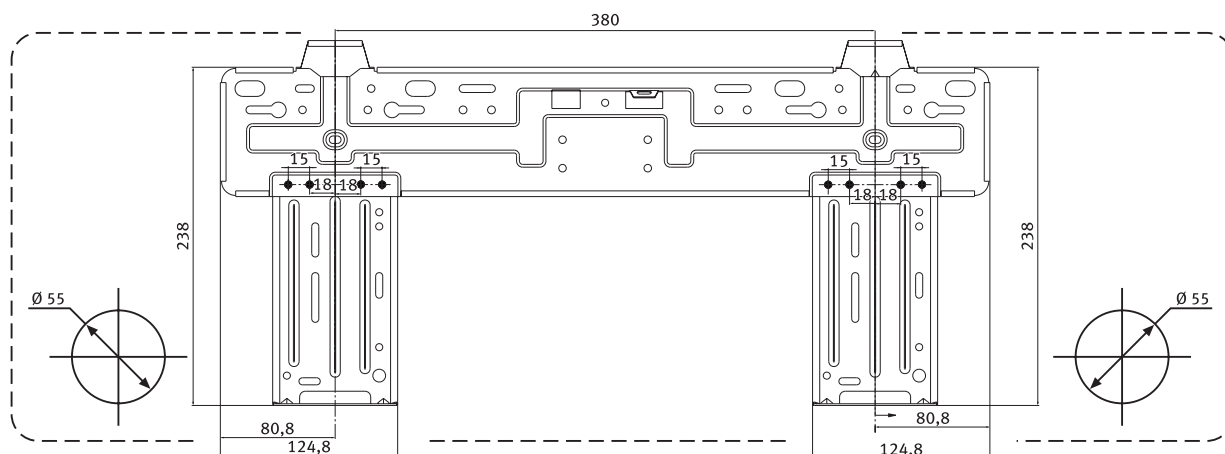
Placa de montaje para 3-025 WNI y 3-035 WNI.
